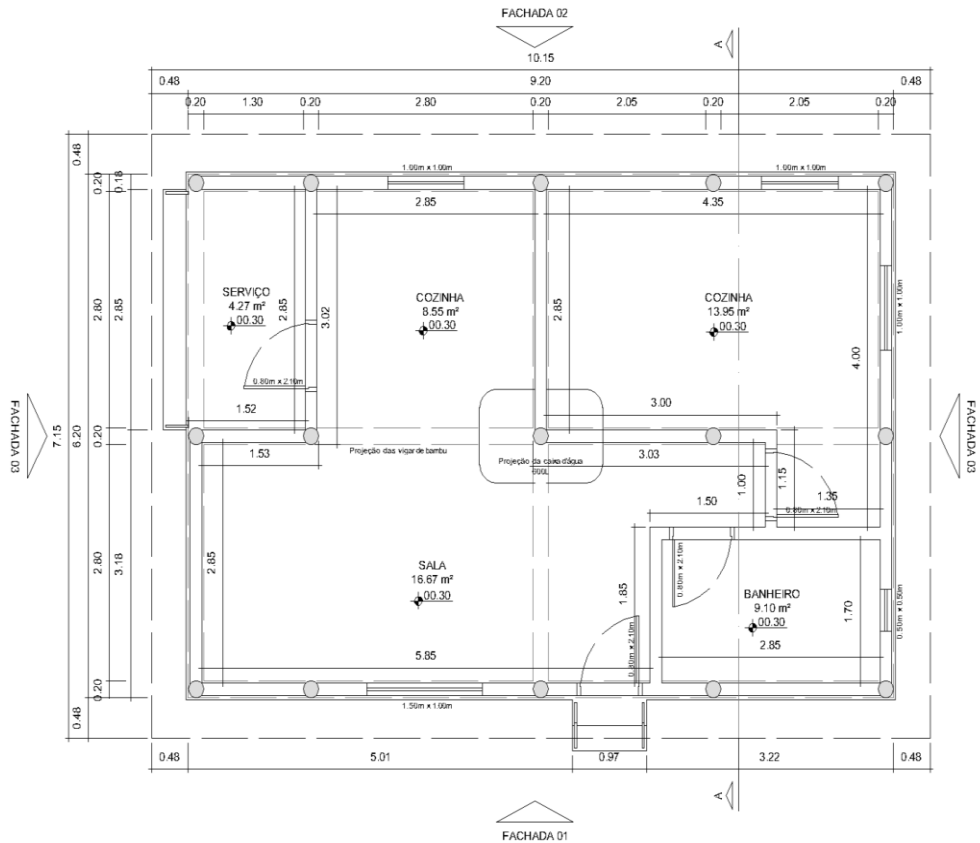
Planta baixa técnica habitação modelo em bioconstrução.
